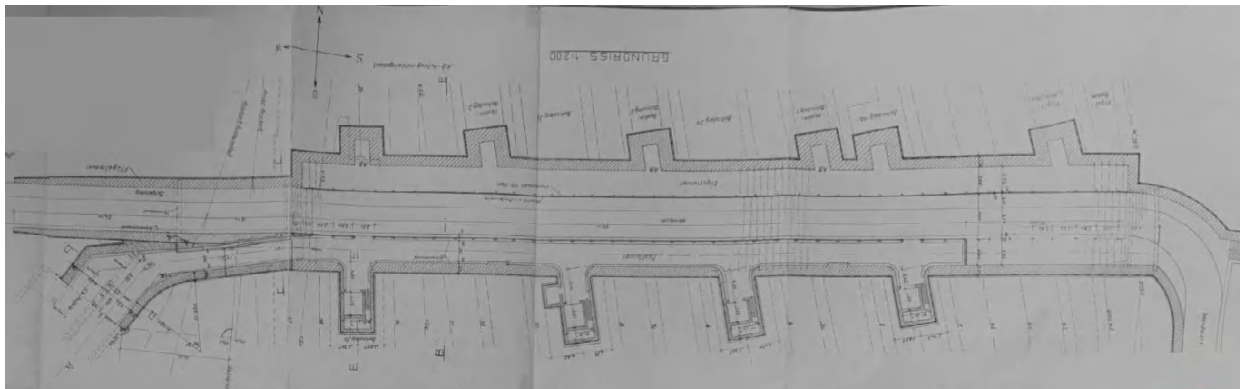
Auszug Grundriss aus dem Bauwerksplan EÜ Werdestraße [DB Netz AG]
